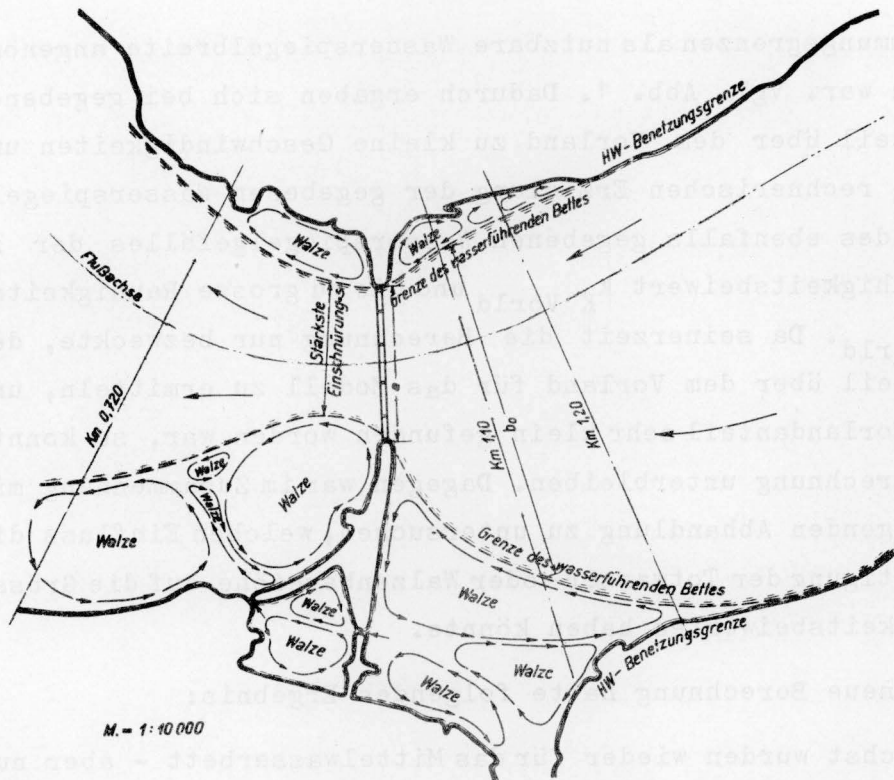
Wasserführendes Bett und benetztes Bett bei einem Fluss mit starker Einschränkung des Hochwasser-Querschnittes durch eine Brücke mit langen Zufahrtsrampen.
